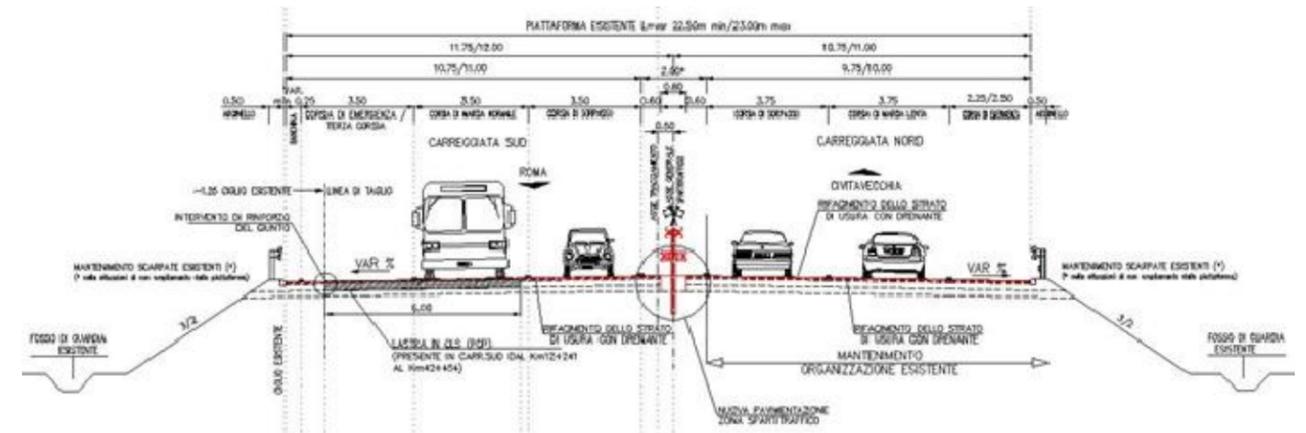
Sezione tipo piattaforma di progetto Autostrada A12
